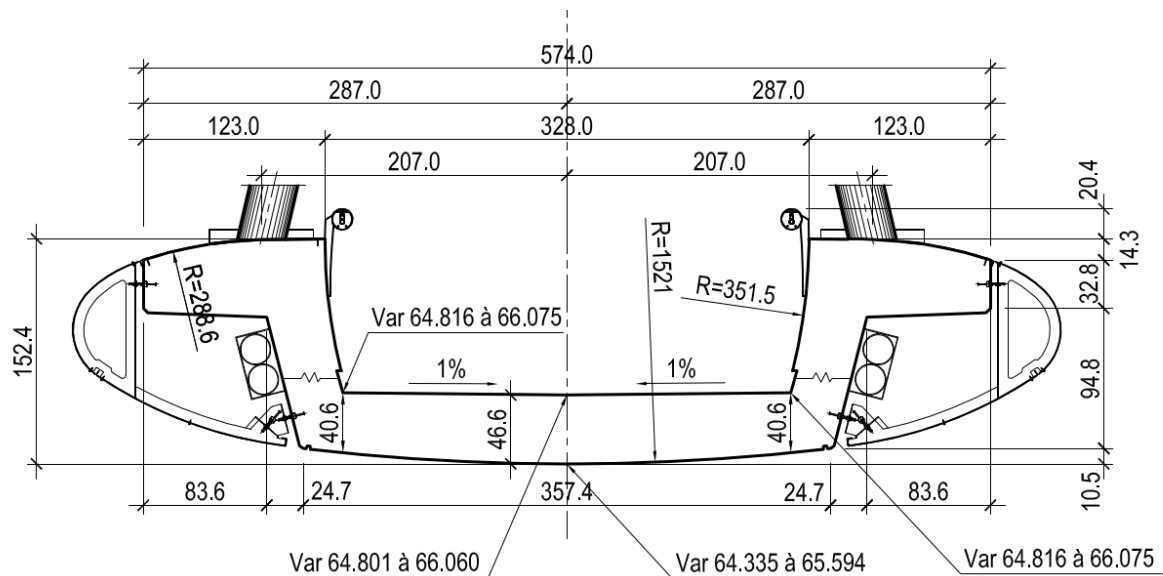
Coupe en section courante du tablier (extrait plans DOE)
